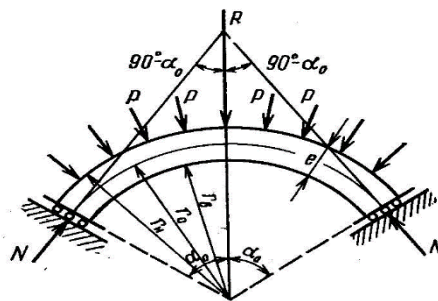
Схема к расчету арки с использованием котельной формулы
